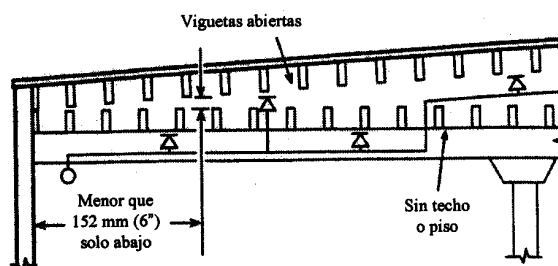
Disposición de los rociadores bajo viguetas dobles, cuando las viguetas inferiores estén sin revestimiento.
